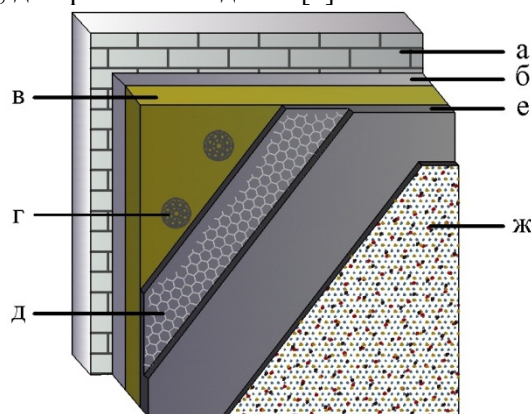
Основные составляющие теплоизоляционной системы строящихся зданий: а – основание; б – внутренний слой предлагаемой отделочной смеси; в – утеплитель; г – дюбель; д – армирующая фасадная сетка; е – наружный слой предлагаемой отделочной смеси; ж – декоративная отделка
